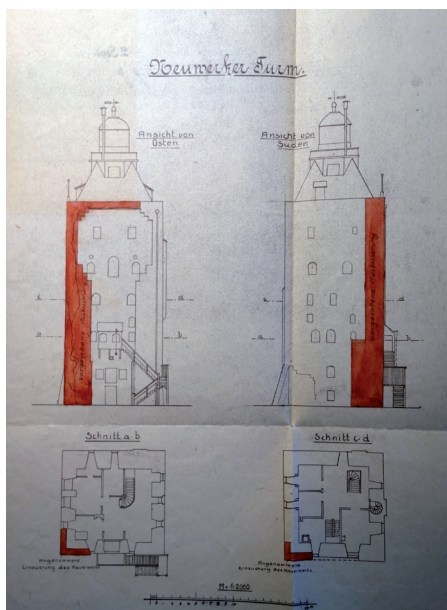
Ansicht Ost und Süd mit ausgewiesener geplanter Erneuerung des Mauerwerks (Südostecke) (STA HH, 111-1_27574).
